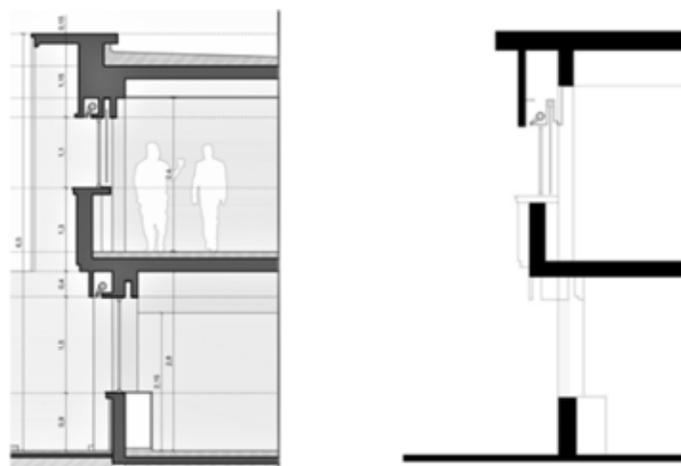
Estudio de fachada. Basamento, Planta nivel de acceso y Planta alta. Ejes y diagrama ventana corrida. Radio Nacional Mendoza.
